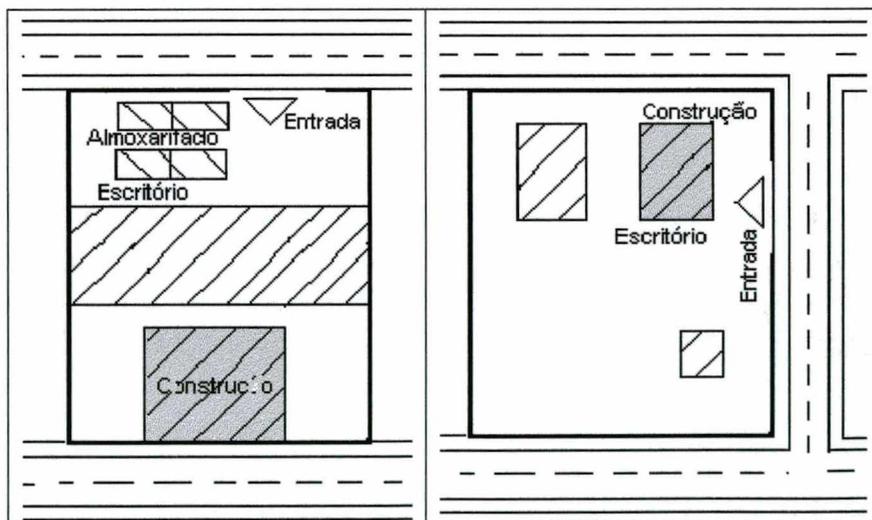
Layout* do canteiro de obra das lajes nervuradas 1 e 2 respectivamente.
